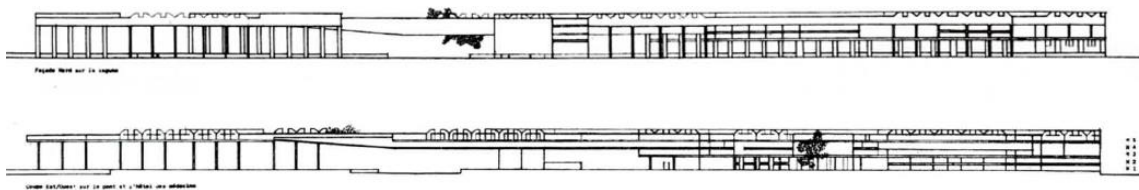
Fachada Norte e Corte Este-Oeste do hospital
